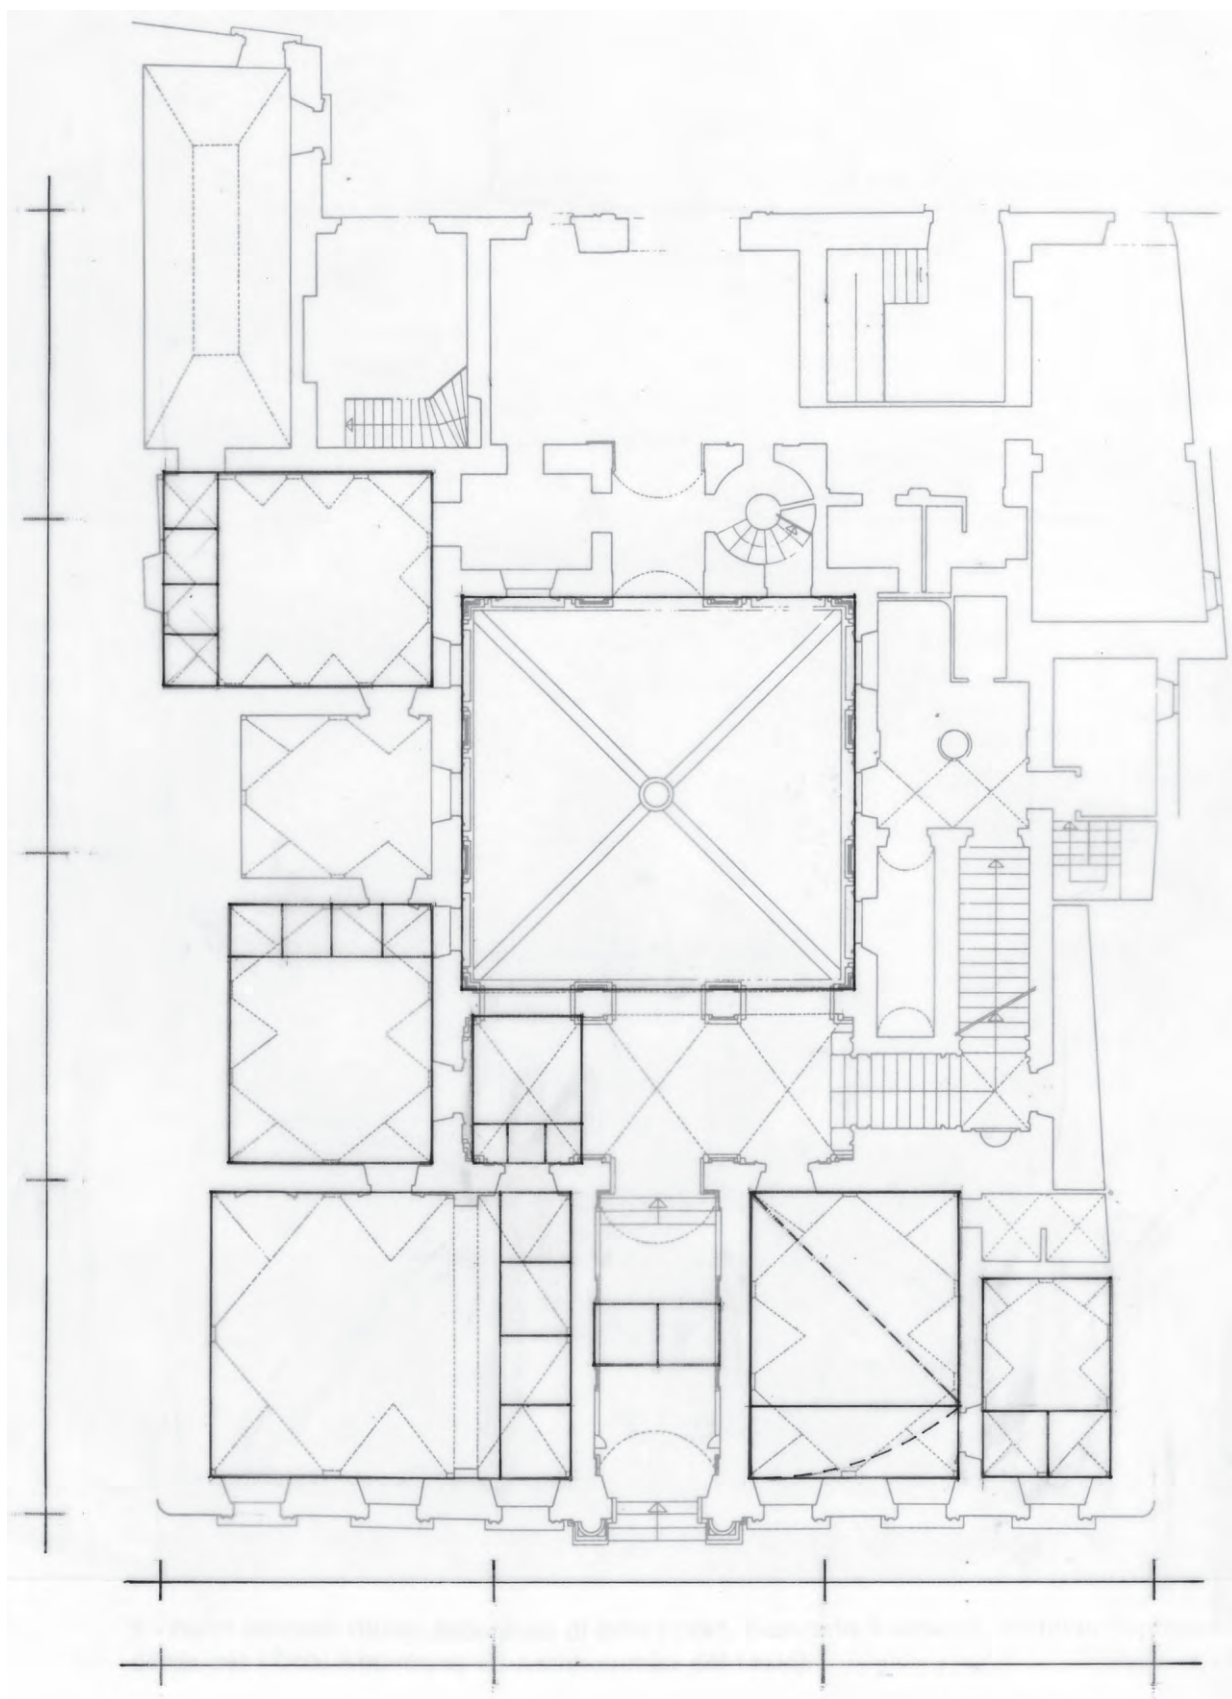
Plan af paladset med proportioner i plan, i mål 1.200.
